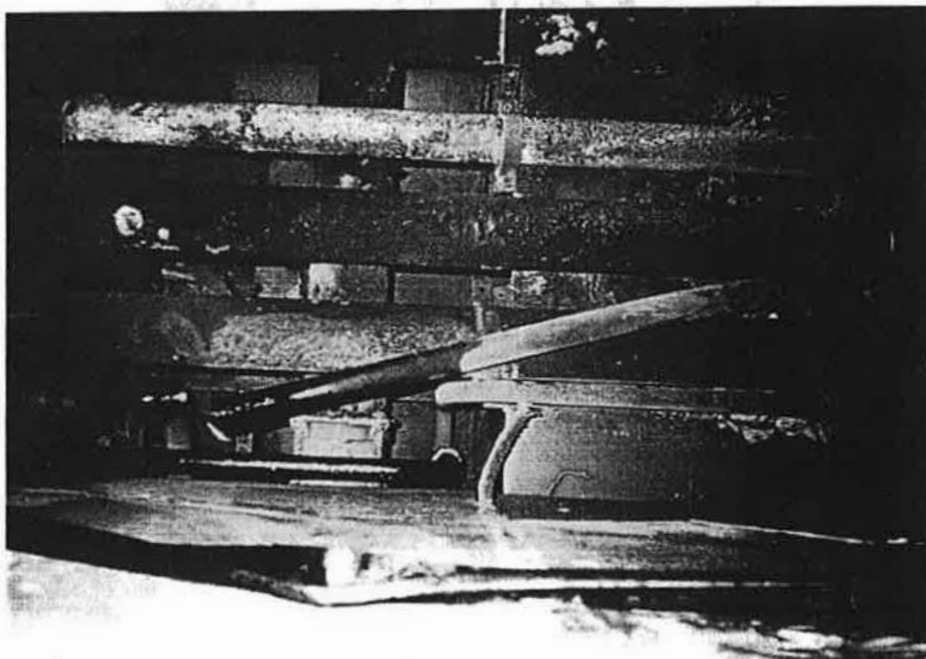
Samme sted som foto nr. 1. Returoilierøret er bukket.
